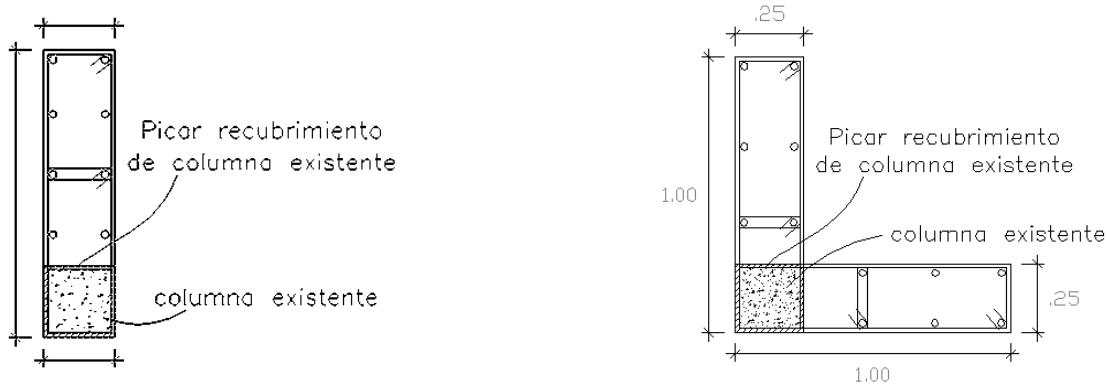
Detalle de reforzamiento para columna existente y esquinera.
